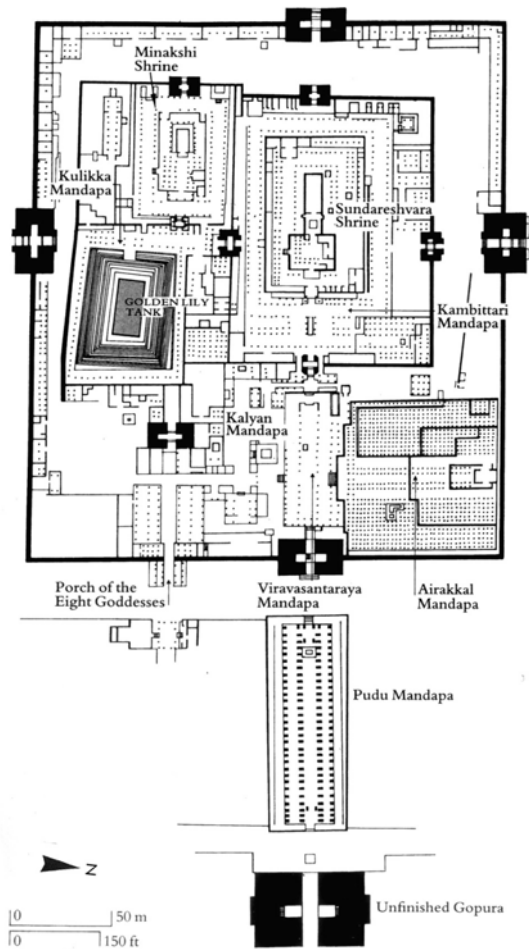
Grundriss Śrī Meenakshi-Tempels/Madurai
